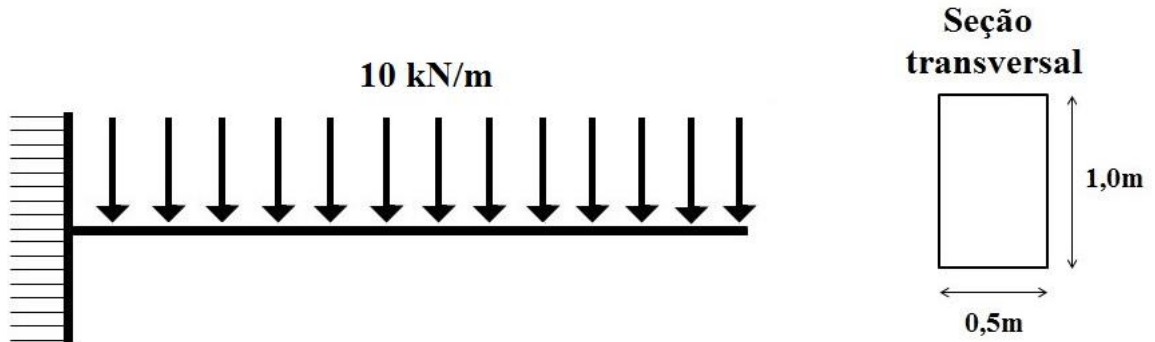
Viga em balanço submetida a um carregamento uniformemente distribuído
